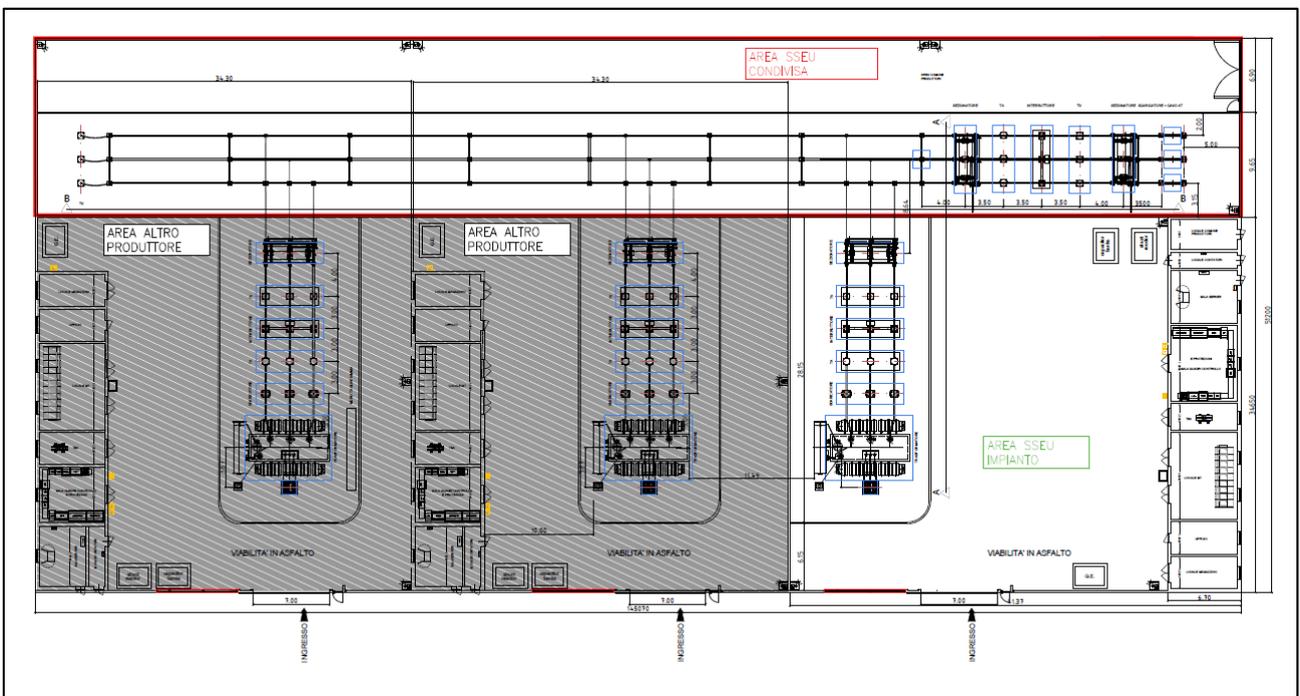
Sotto stazione utente-SSE. Planimetria
